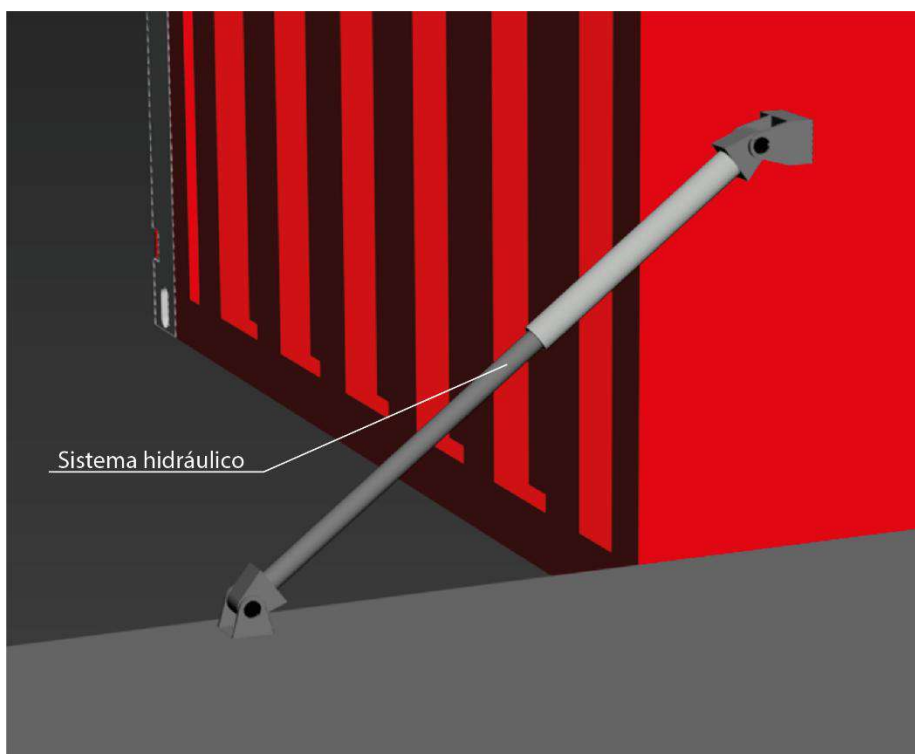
Render detalle hidráulica container “Fuente: Elaboración propia”
